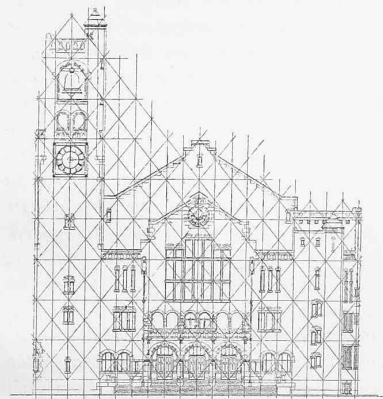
Fassade des neuen Börsengebäudes zu Amsterdam mit eingezeichneten Konstruktionslinien. Architekt H. P. Berlage.
